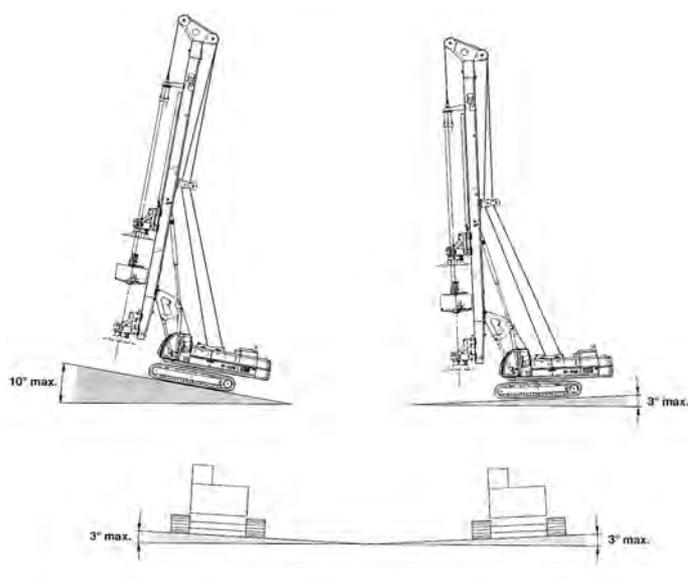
Ejemplo de inclinaciones máximas con la pilotadora en configuración de traslado y con la torre vertical
